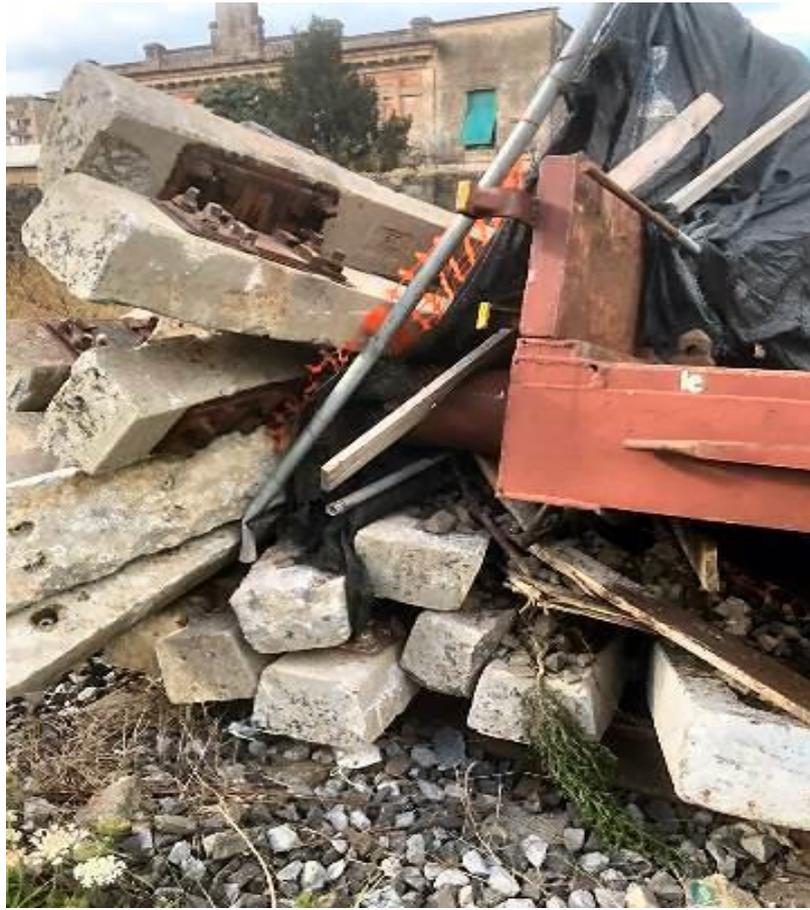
e 02: Posizione statica del primo carro sviato, con dettaglio delle traverse urtate (fonte Ufficio)
